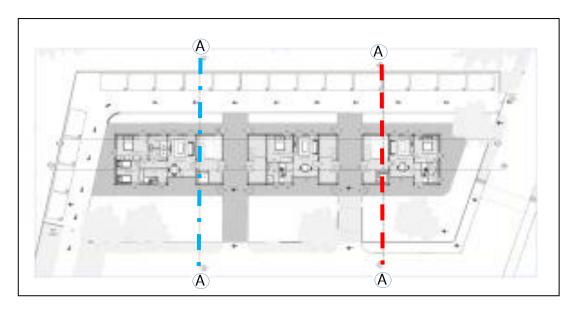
plan d'ensemble de bâtiment Trame d'ombra.
